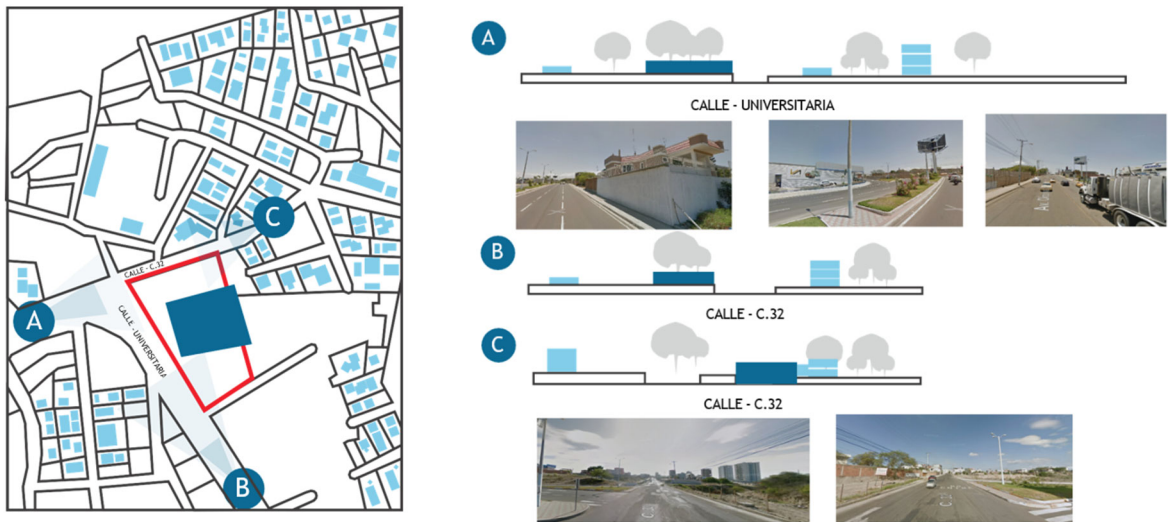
Vistas del proyecto MantaCar. Fuente:(AutoBIM, 2025)
